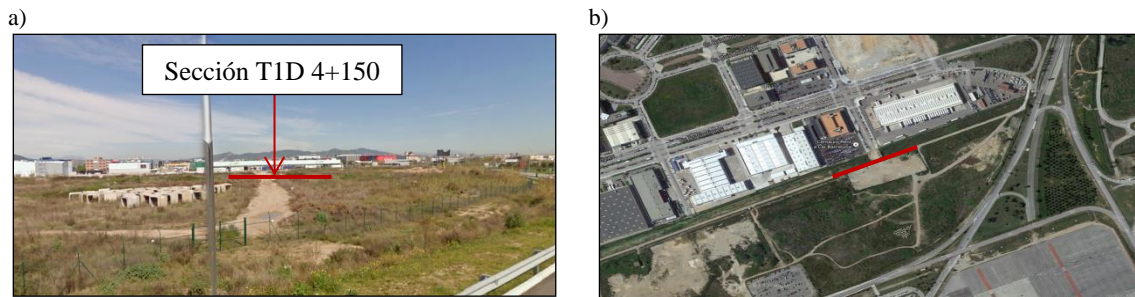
12. a) Vista desde satélite en alzado b) Vista desde satélite en planta, sección T1D PK 4+150. Fuente: Google Maps
